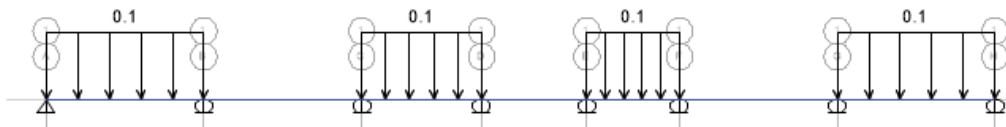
Carga viva distribuida en vigueta de losa aligerada – Damero 1
